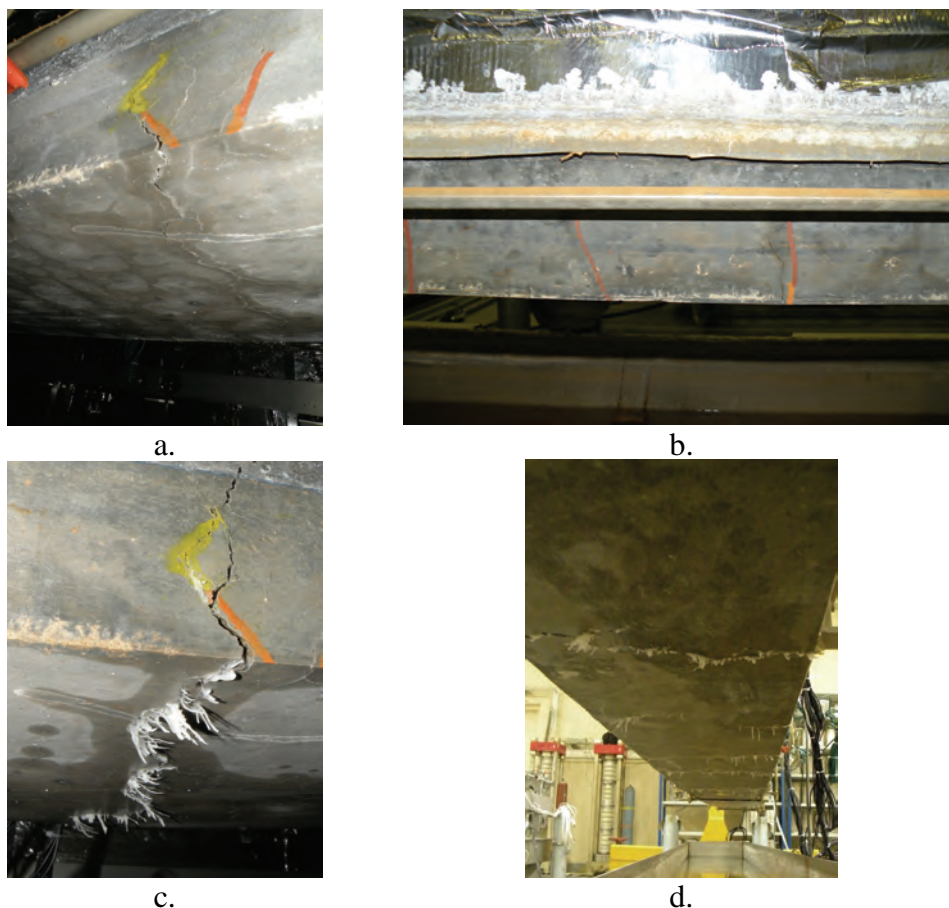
fissuration de la poutre P5 (partie 1)
